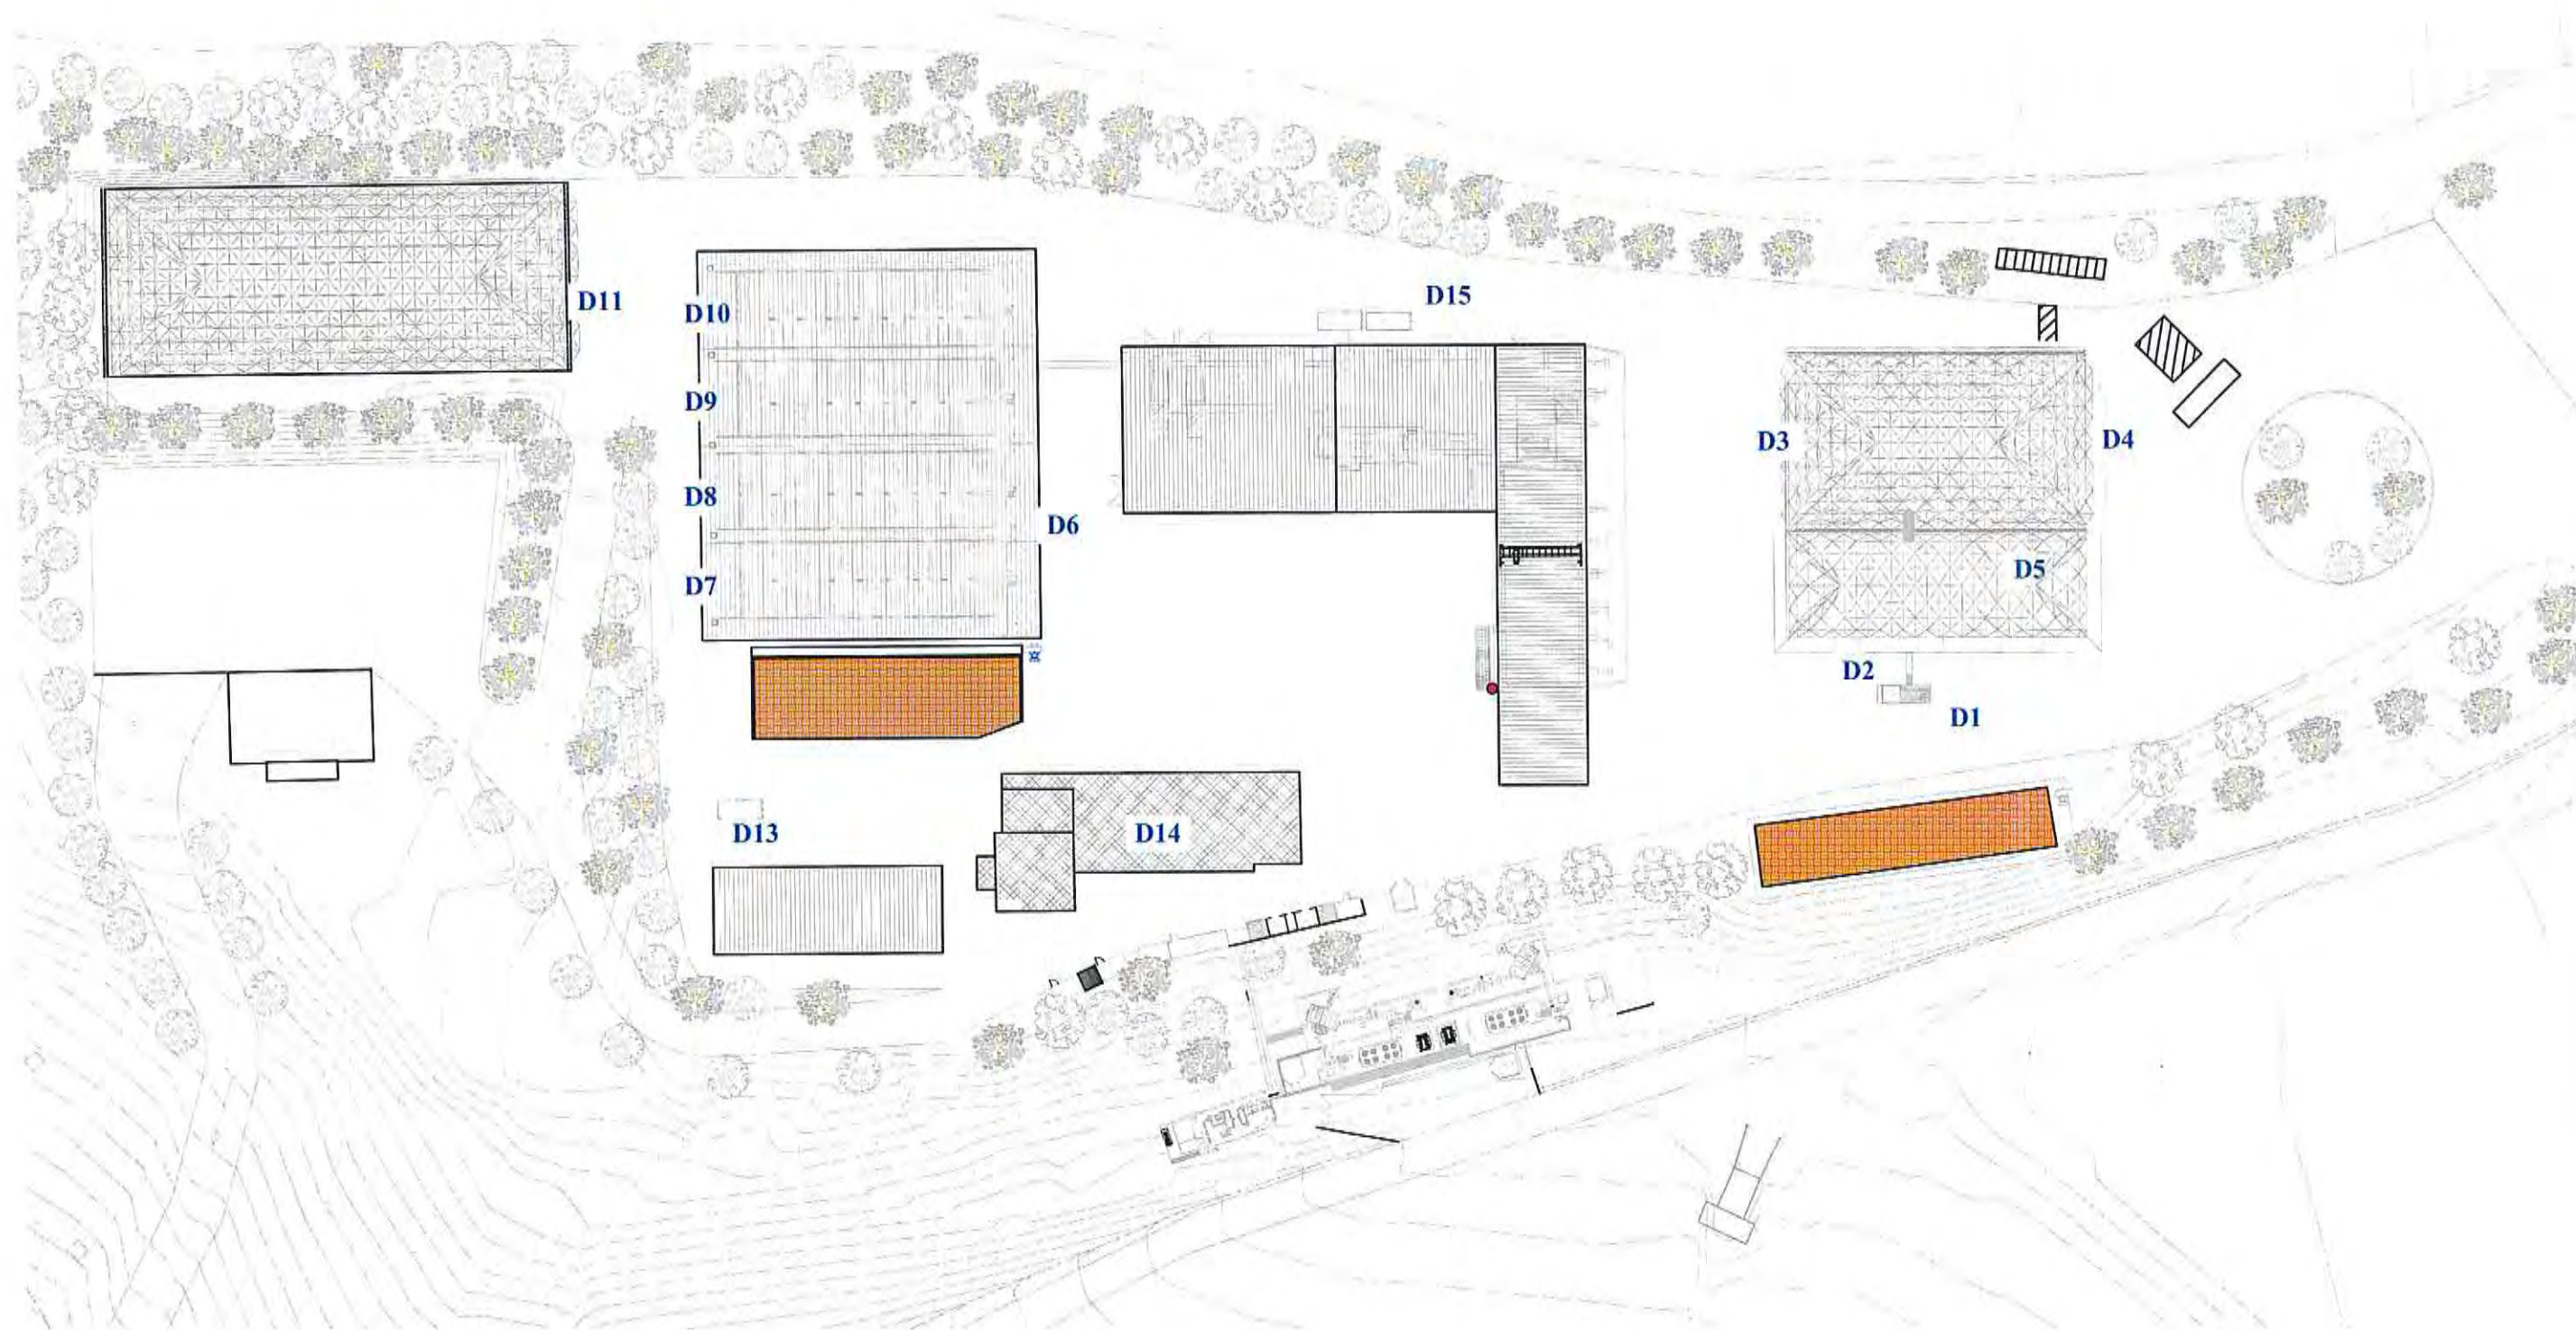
Planimetria con individuazione emissioni diffuse stato Attuale
